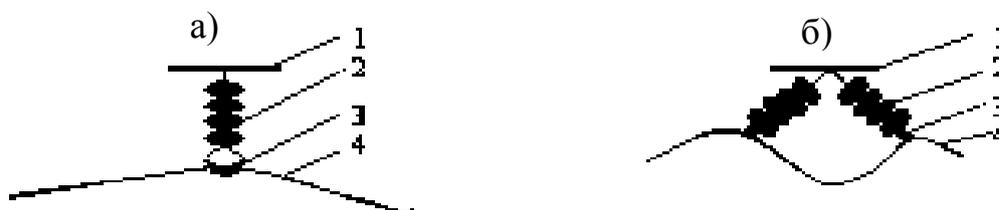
Крепление провода в фазе на промежуточной (а) и анкерной (б) опорах:
